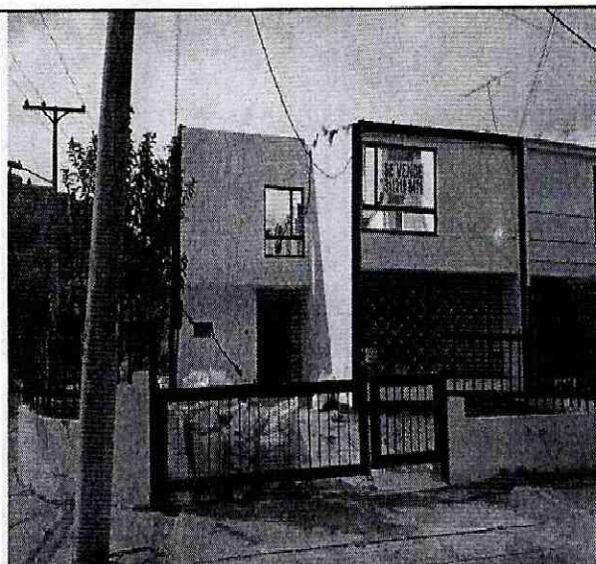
Fachada con grietas y fracturas de la mampostería.
